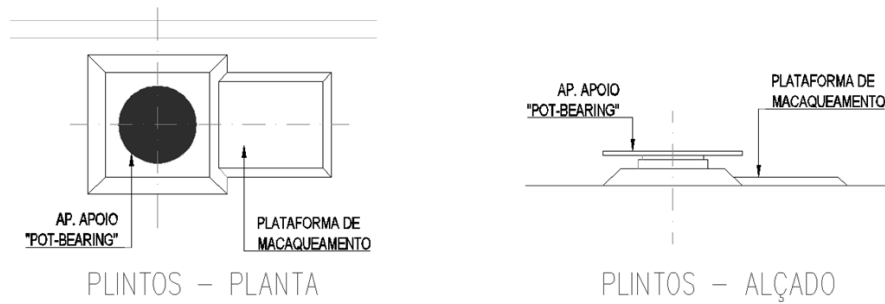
Plataformas de Macaqueamento nos Aparelhos de Apoio, em Planta e Alçado
